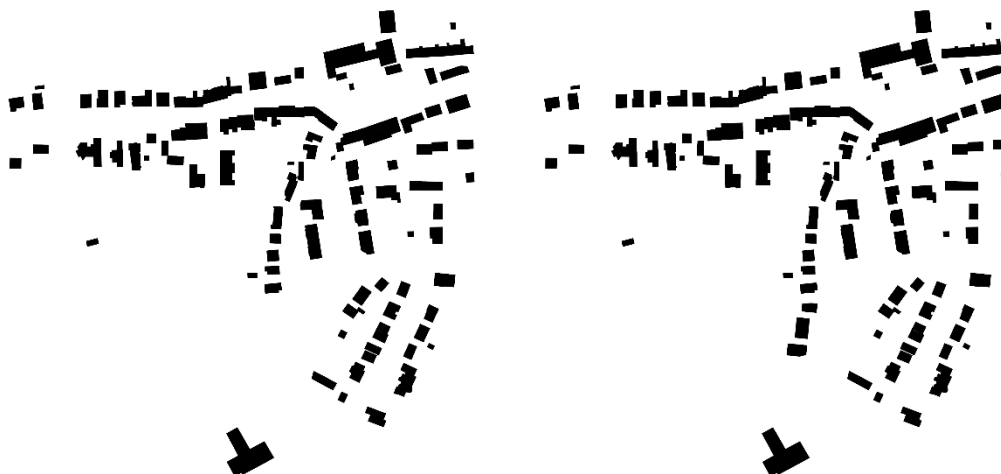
Plan masse des volumes construits aux abords du site de projet : avant (à gauche) et après le PAP (à droite), Source: a+a
